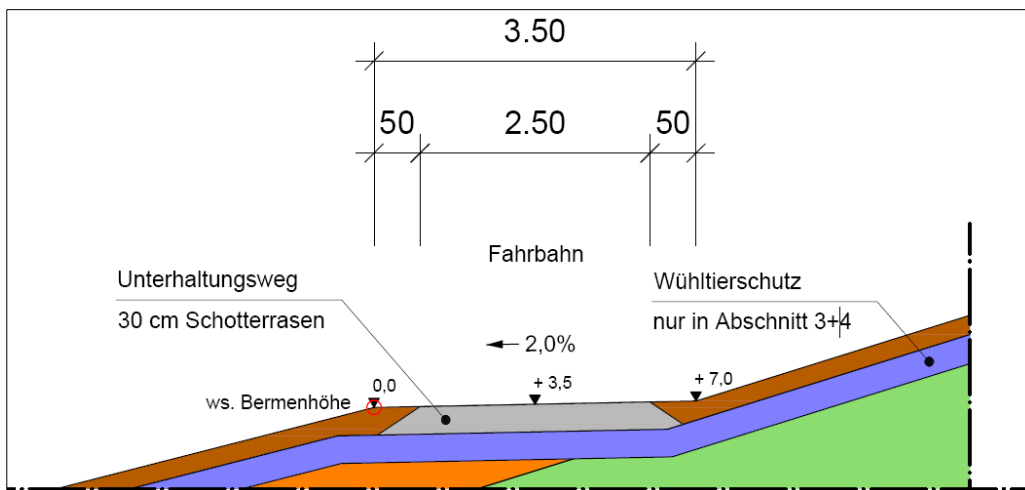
Regelprofil wasserseitige Unterhaltungsberme (Ausschnitte der Plandarstellung)
